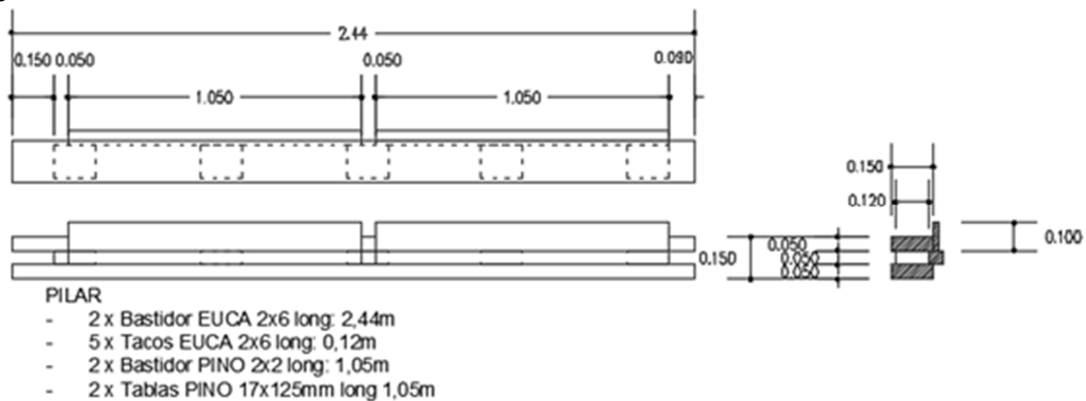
Detalle constructivo de las columnas. Fuente: Documentación provista por TECHO.
